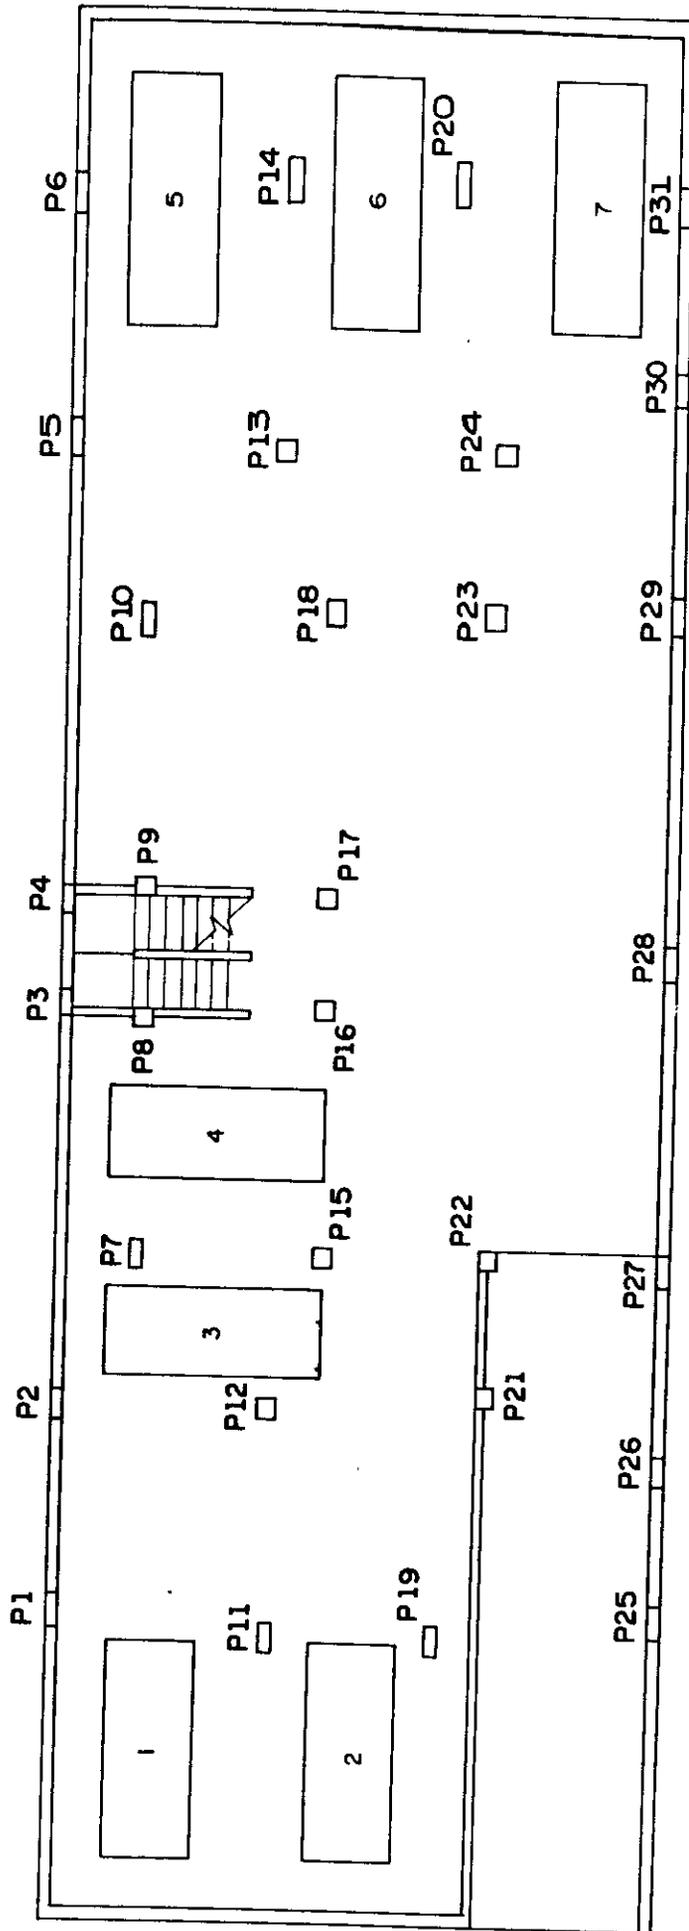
c - Estrutura III - Posicionamento dos Pilares na Garagem do Edifício B
